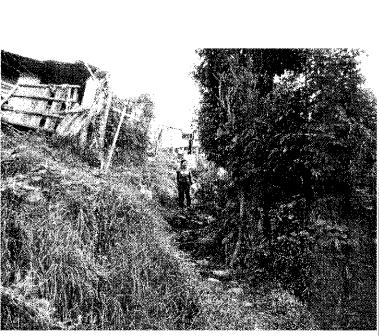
Vista de la parte media del sector donde se emplazan las viviendas evaluadas y detalle del sendero de acceso.
